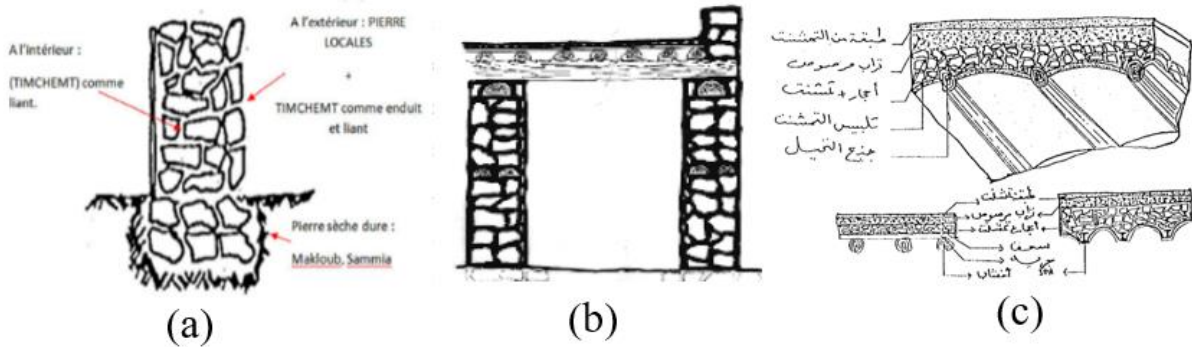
Des croquis des techniques de construction (a) fondation, (b) mur porteur, (c) plancher, de la maison traditionnelle du ksar et des matériaux qui la composent. Source : PPSMVSS Ouargla.
